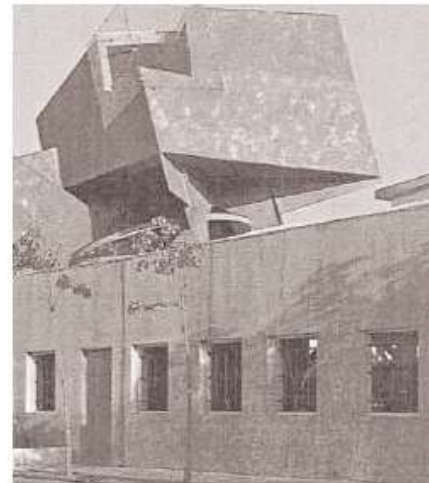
Ouvrages sur le toit d'immeubles : configurations à éviter.
